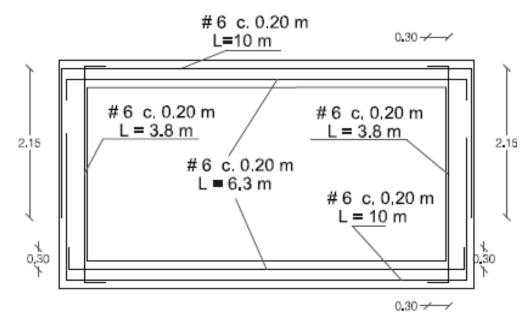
PLANTA DE CIMENTACION ESTRIBO No. 1
